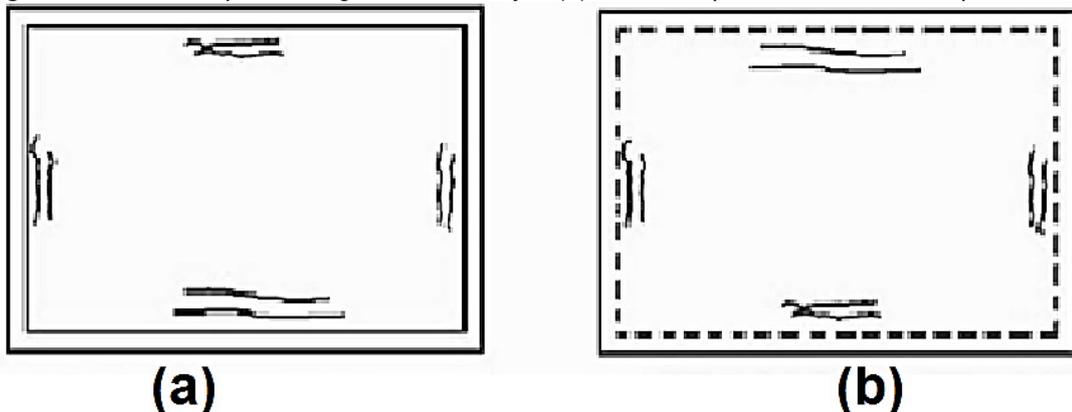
Fissuras causada devido a deficiência de armadura (a); fissuras na face inferior da laje
